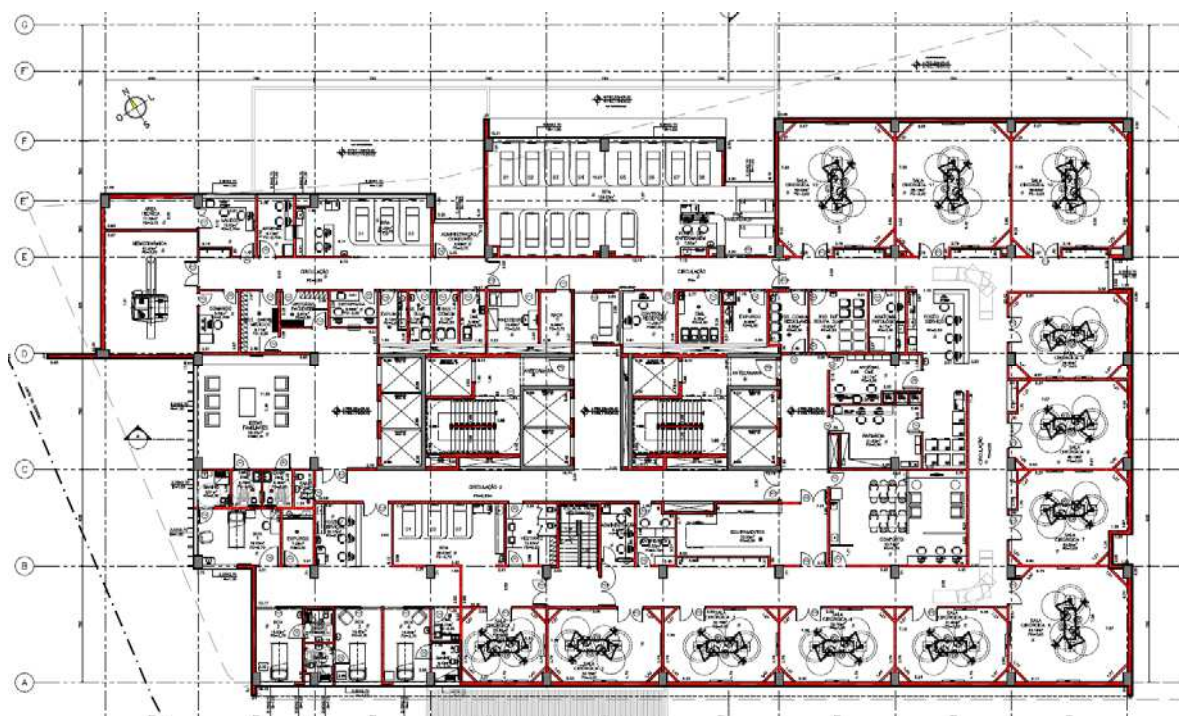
Planta do 4º Pavimento – salas de cirurgia.
